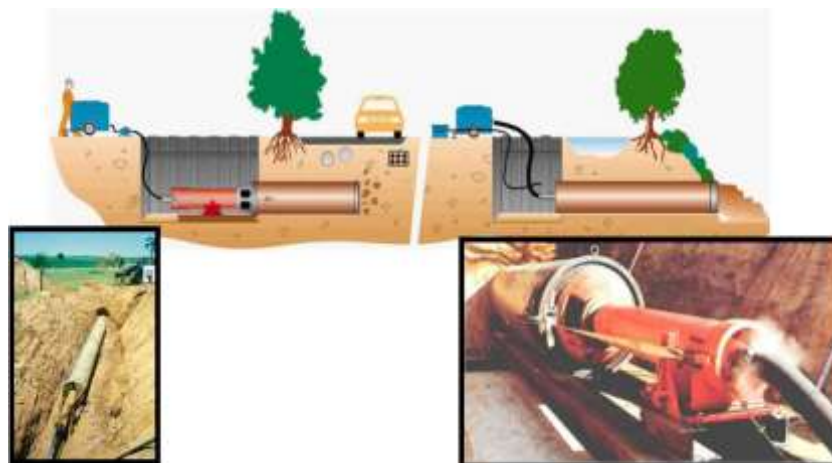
Esquema de uma perfuração por cravação de tubo com extremidade aberta e detalhes da execução de uma perfuração por cravação à percussão. Fonte: adaptado de ABRATT (2020).
